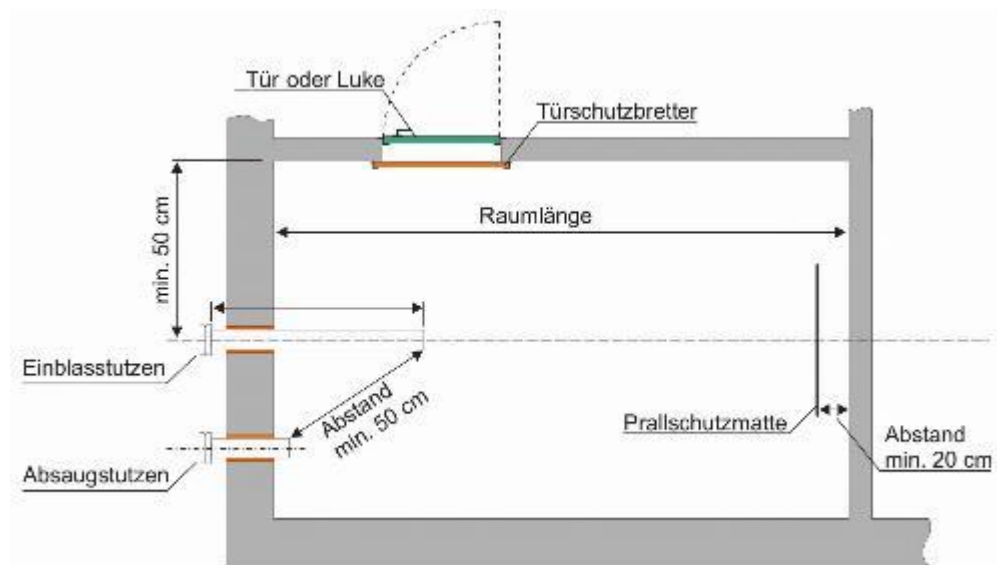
Grundriss eines Pelletlagerraums
